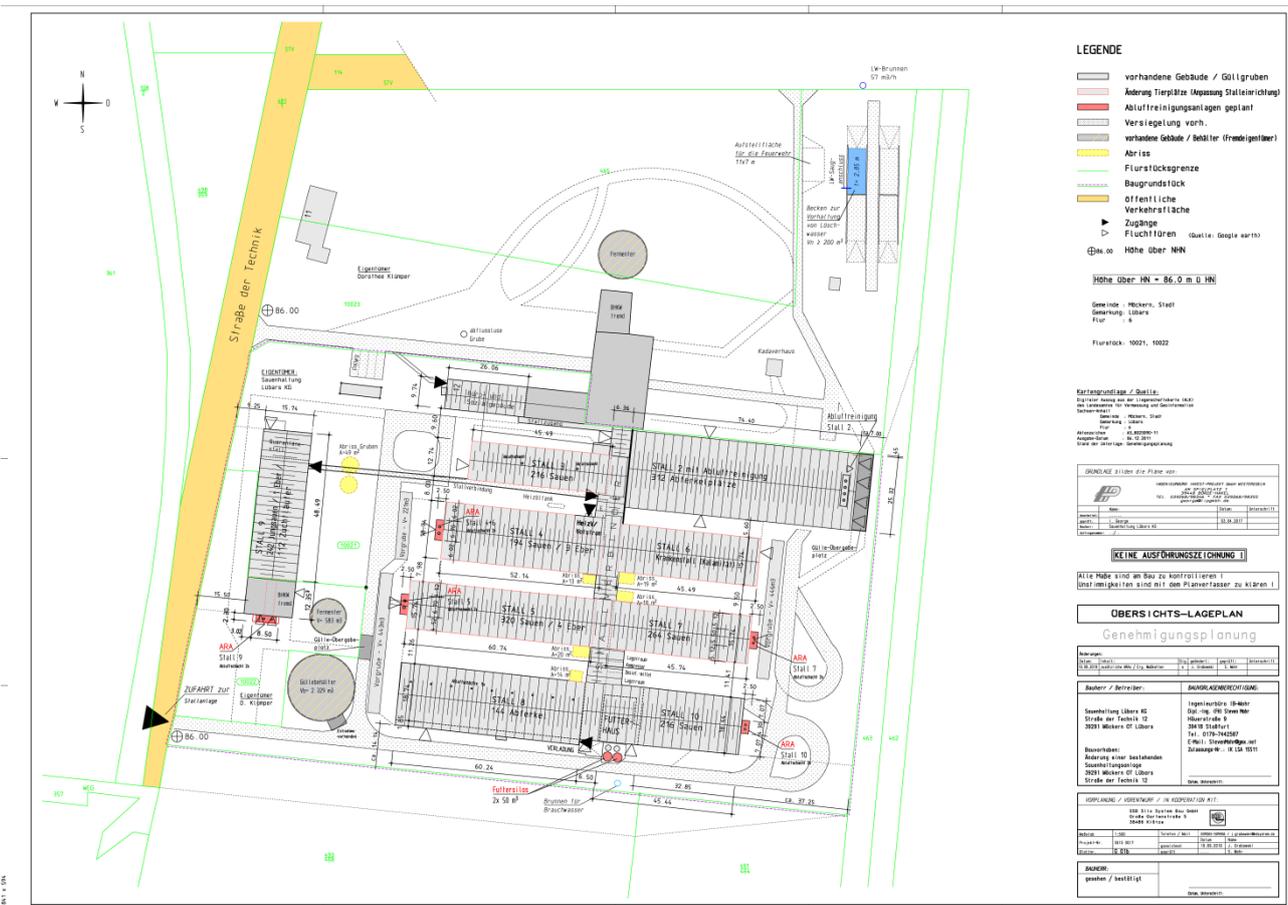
Anlagenplan der Tierhaltungsanlage im Plan-Zustand
